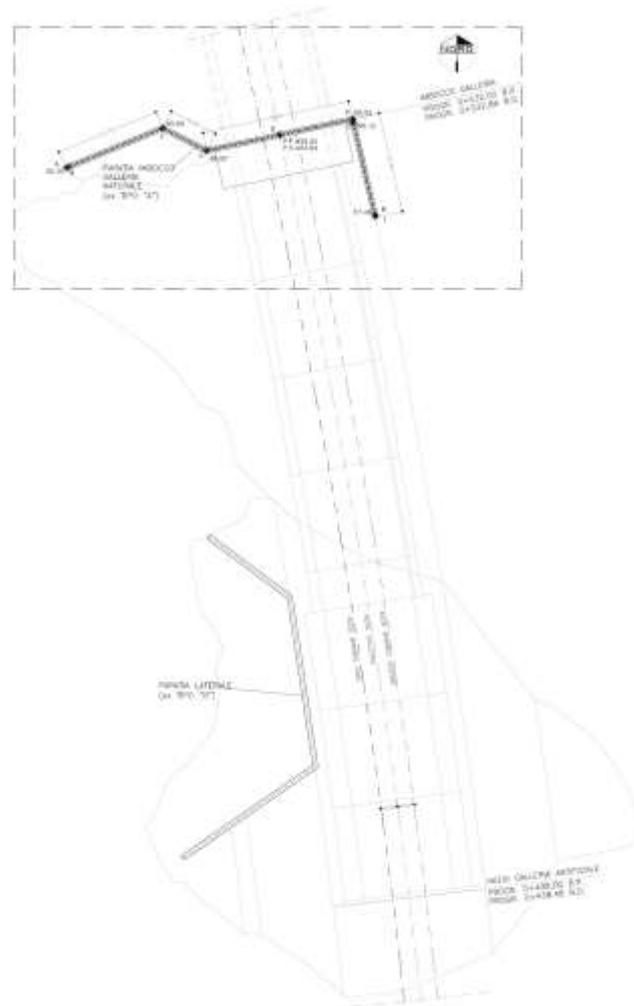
Planimetria dello stato di fatto nella zona dell'imbocco
